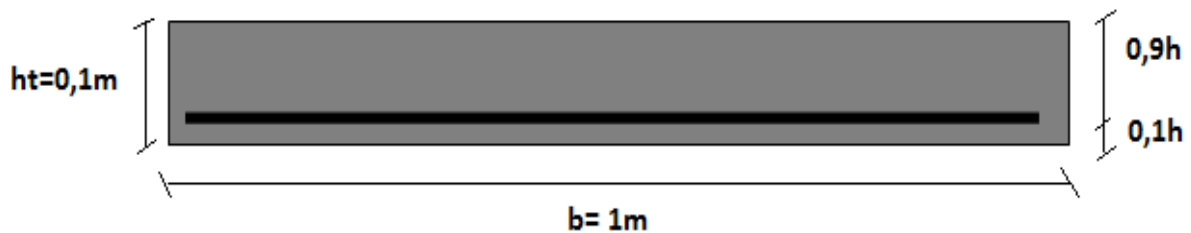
coupe transversale d'un mètre linéaire de l'acrotère
